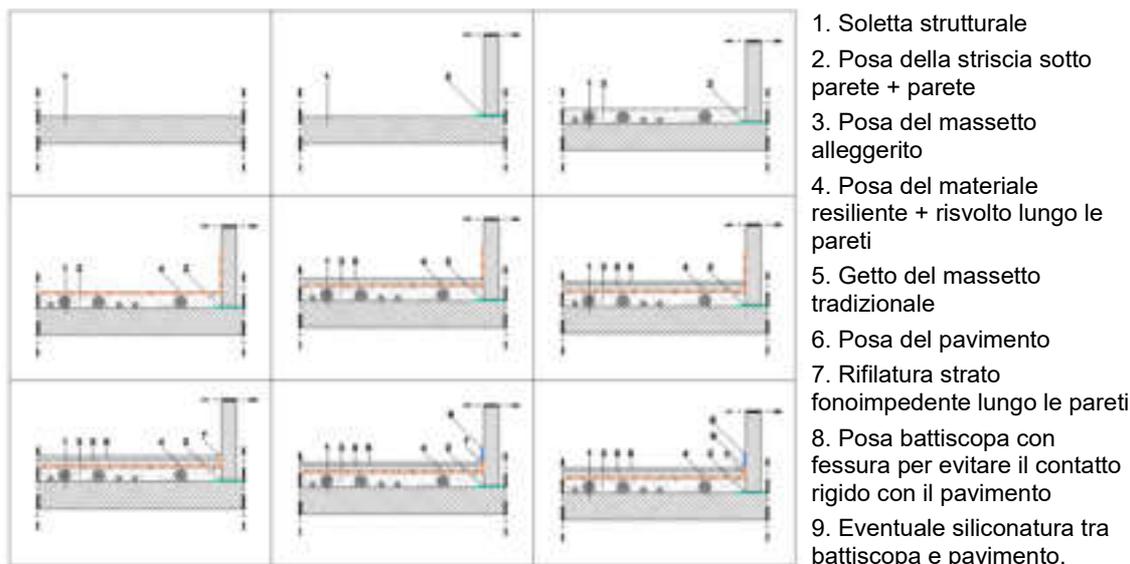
Modalità di posa in opera del pavimento galleggiante
